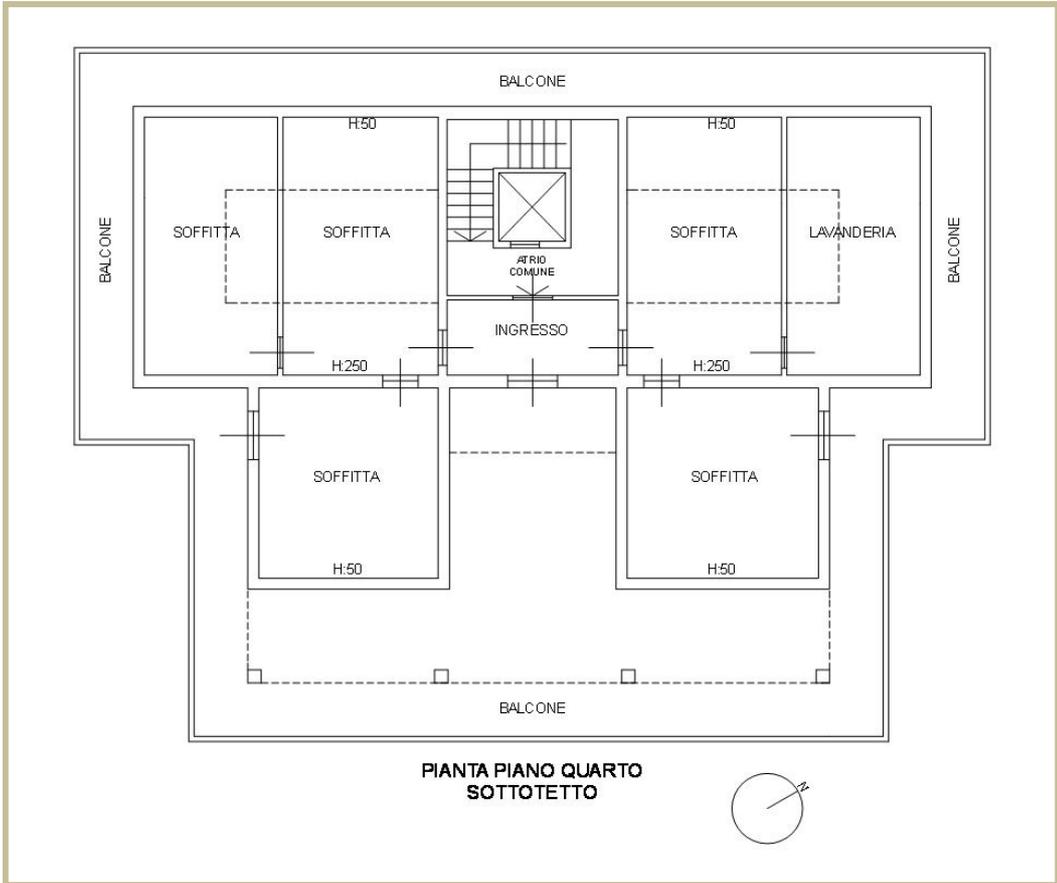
PIANTA P4 SOTTOTETTO STATO LEGITTIMATO
